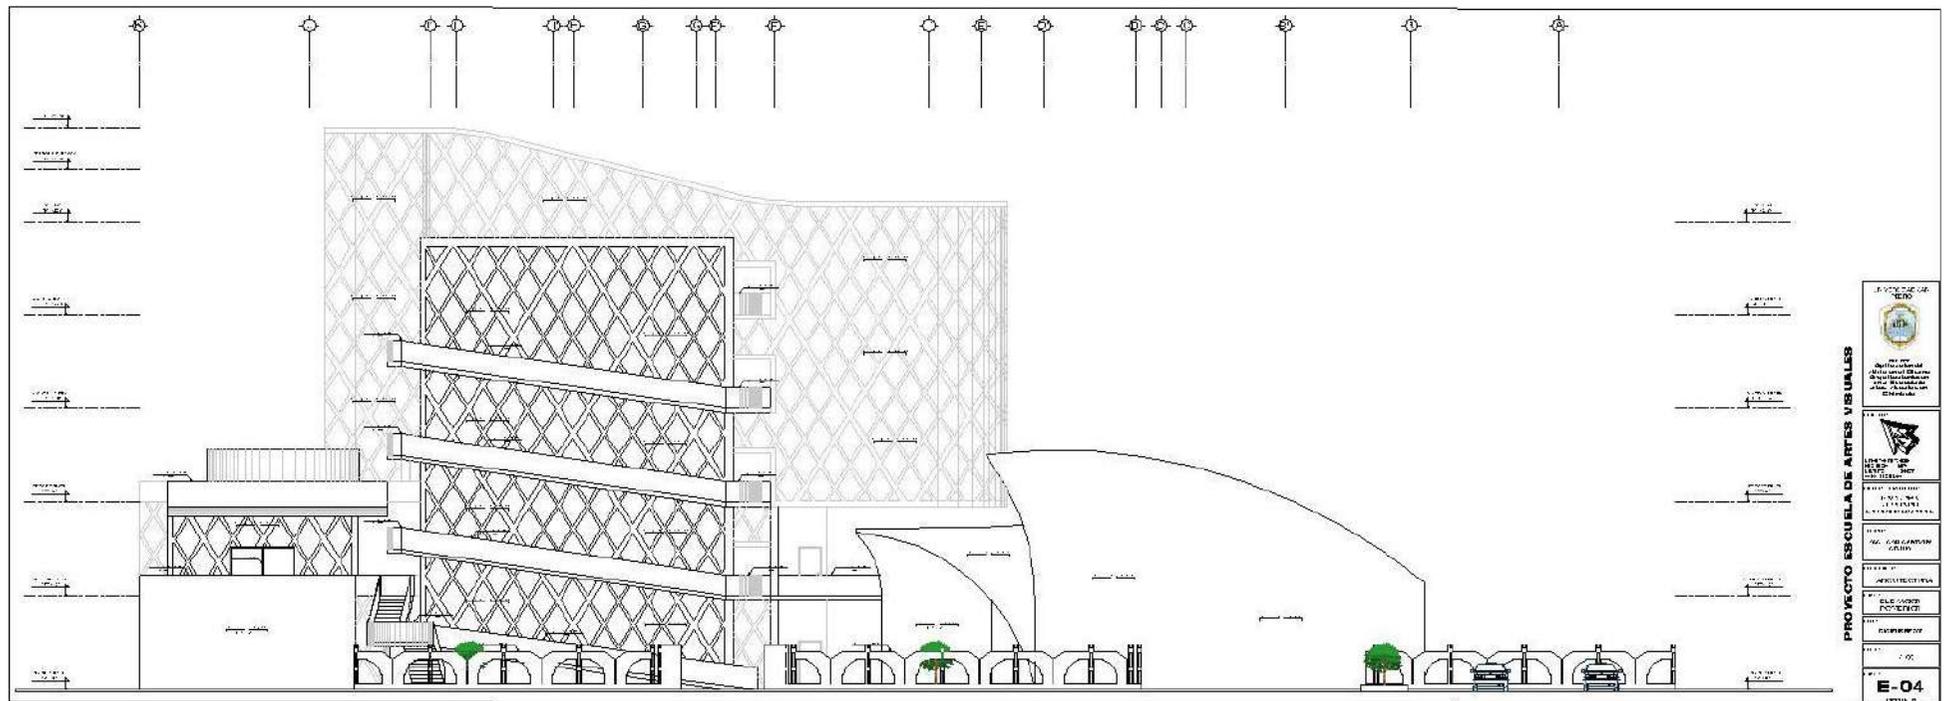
Plano de Elevación Frontal del Proyecto Arquitectónico
